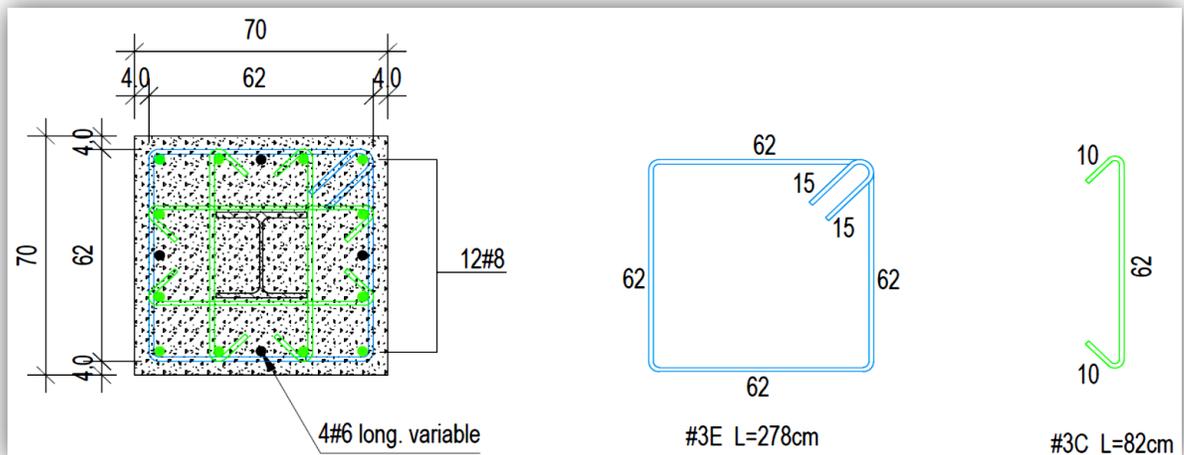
Refuerzo transversal de las columnas de 0.70 m x 0.70 m.
